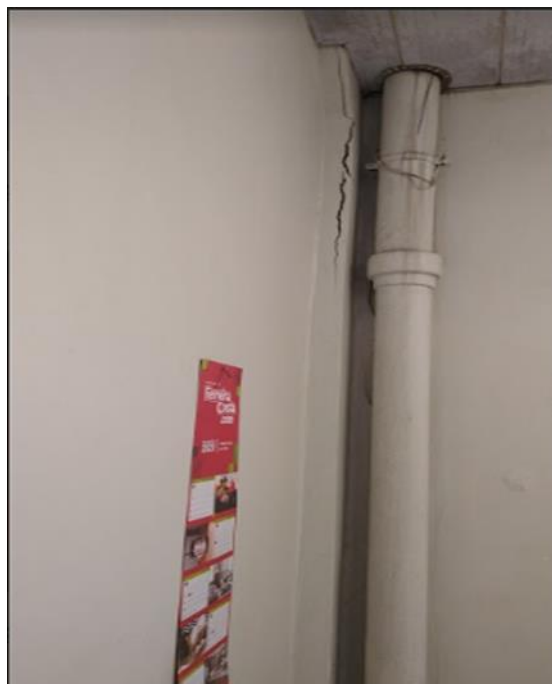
Sinais de infiltração e necessidade de recuperação estrutural
